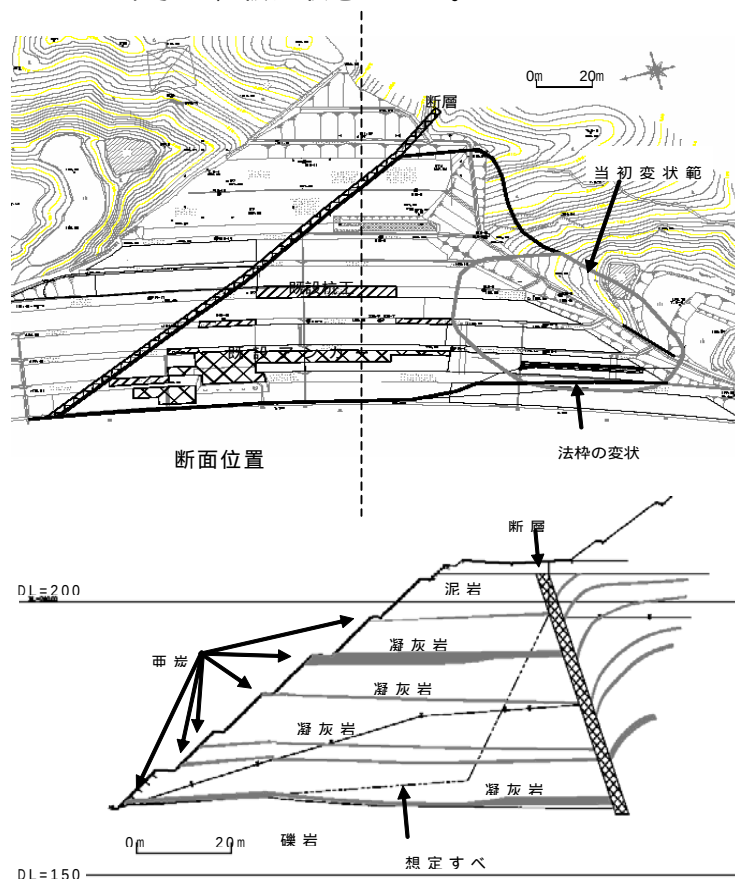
1 1 事例 3 の変状平面図と地質断面図
